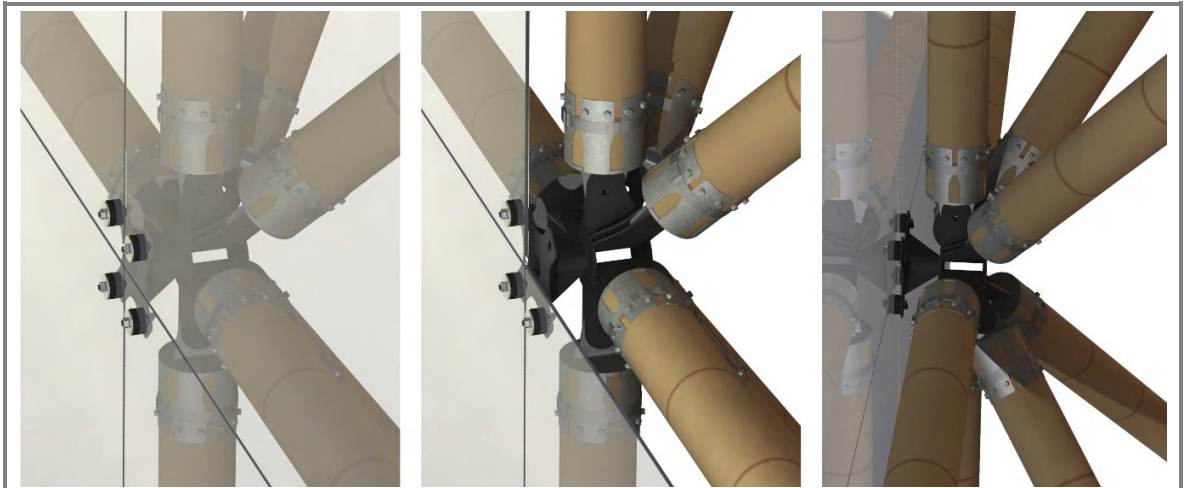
Sistema de cerramiento en vidrio tipo araña para fachada
